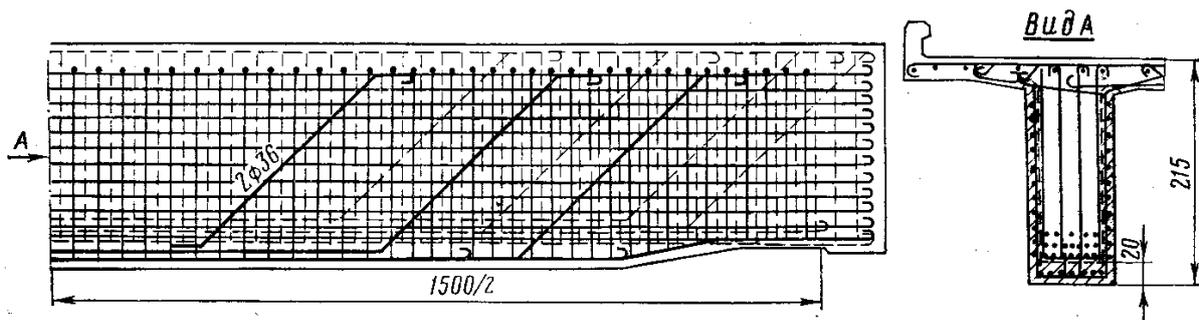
Усиление пролетного строения железобетонной оболочкой (на фасаде балки показана только арматура усиления)
